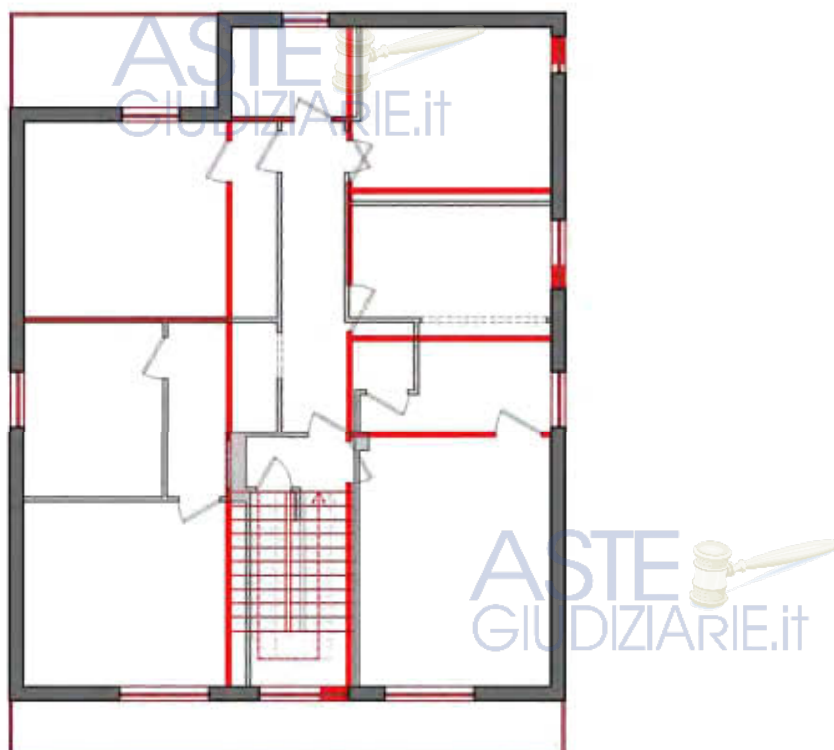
Sovrapposizione planimetria catastale (in rosso) su rilievo stato di fatto - Lotto Uno
